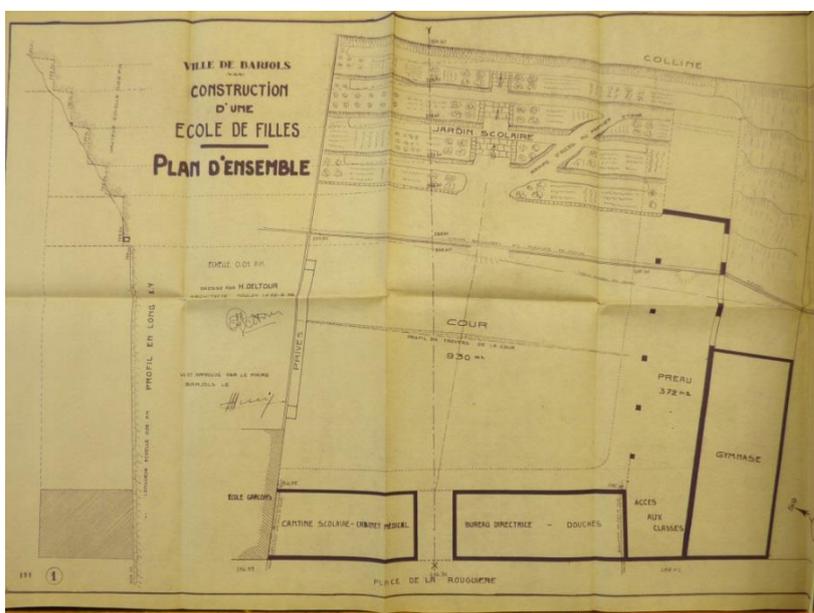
Construction d'une école de filles, plan d'ensemble, Henri Deltour (architecte).
